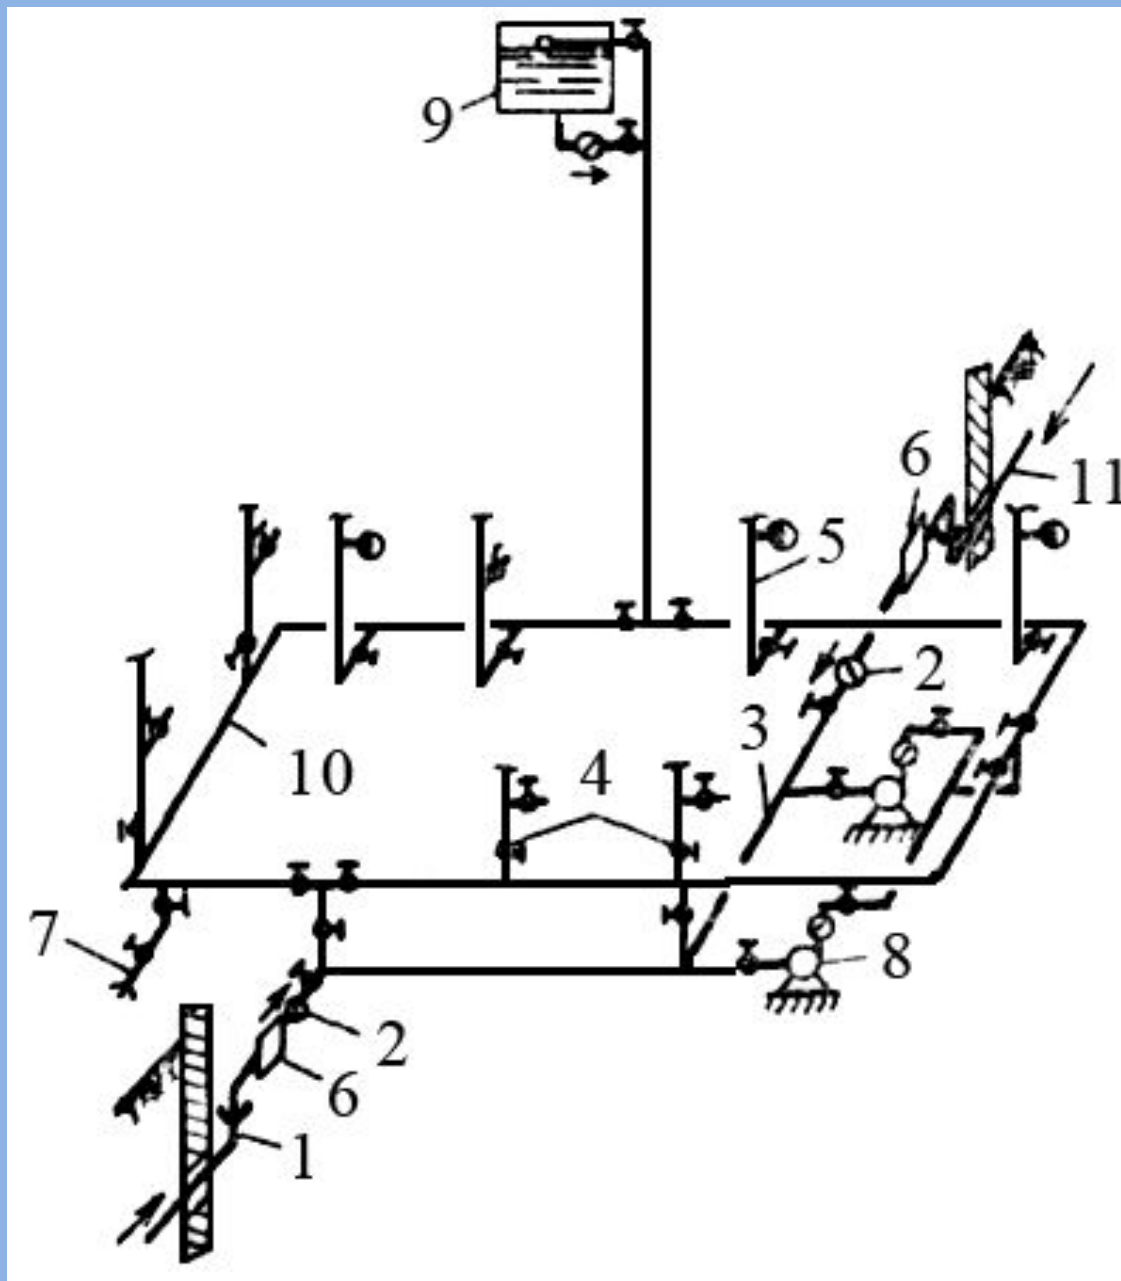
Система водоснабжения здания с водонапорным баком и повысительной насосной установкой:
